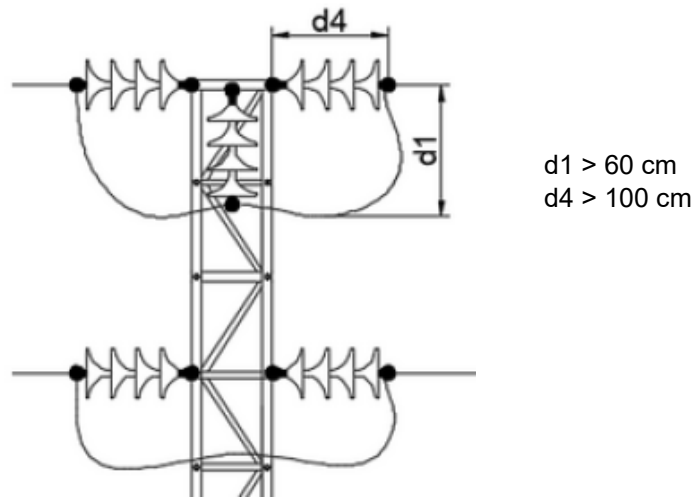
Montaje en 1 con cadenas de aisladores en amarre
